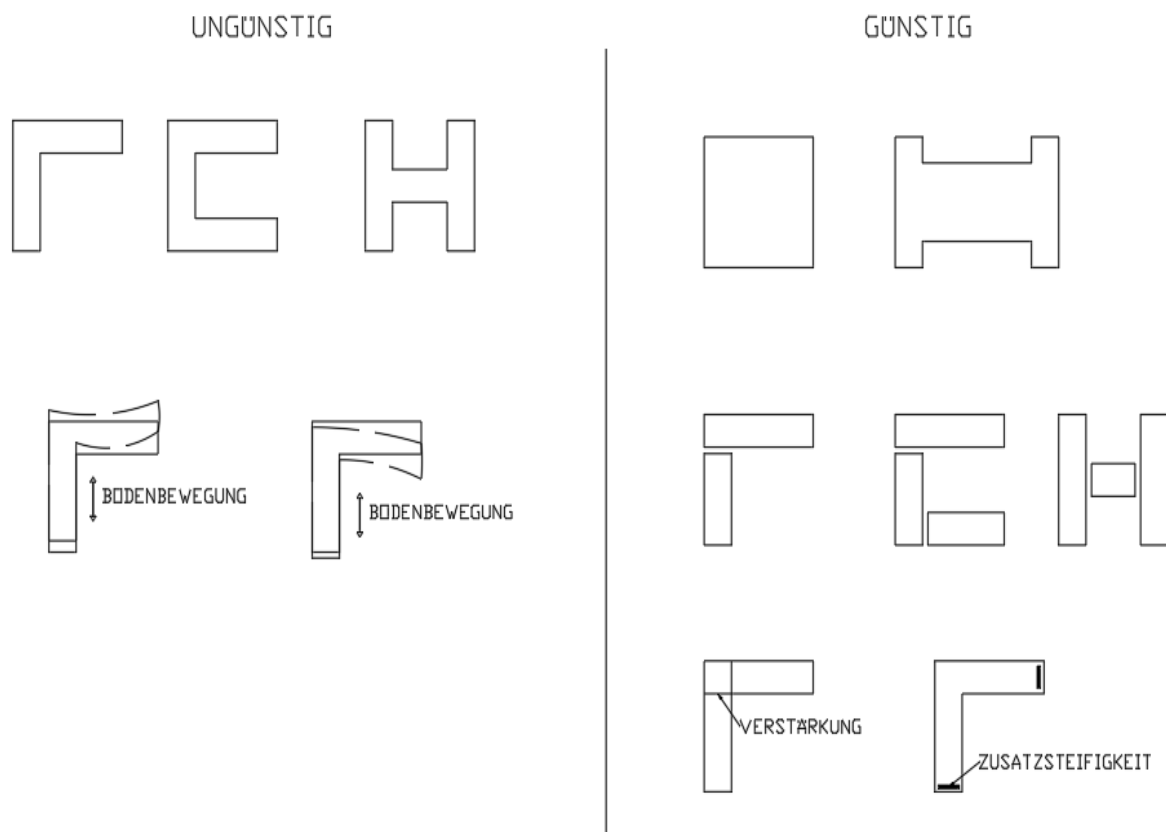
Günstige und ungünstige Grundrisse [8]
